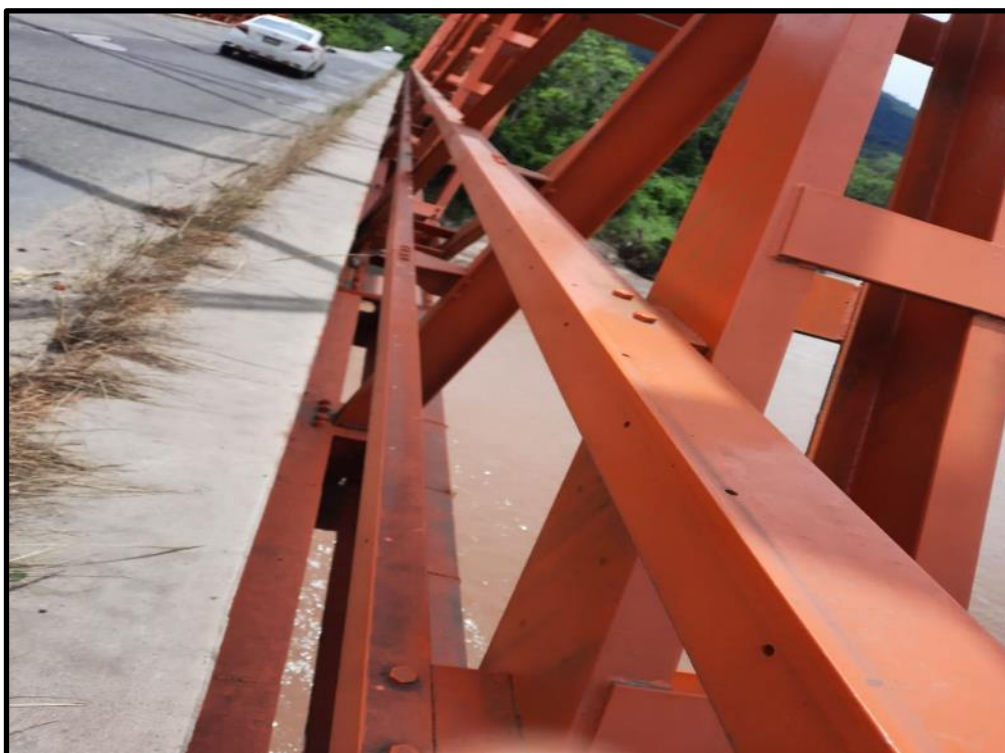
Se aprecia el estado actual de la sección metálica y vereda - Lado derecho
